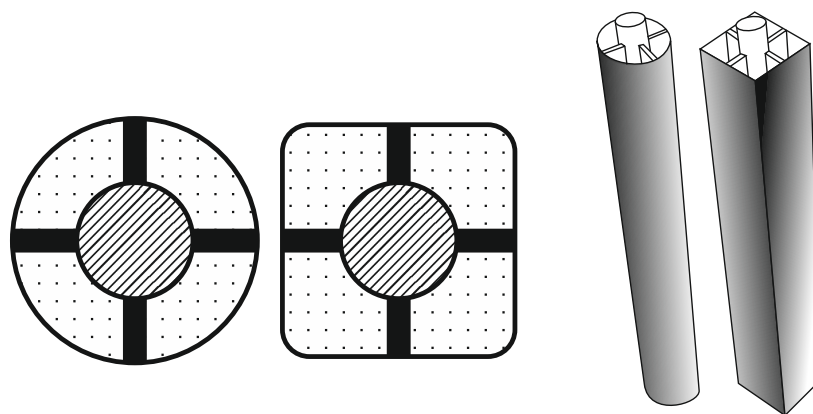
Трубобетонные колонны со стальными сердечниками [13]
